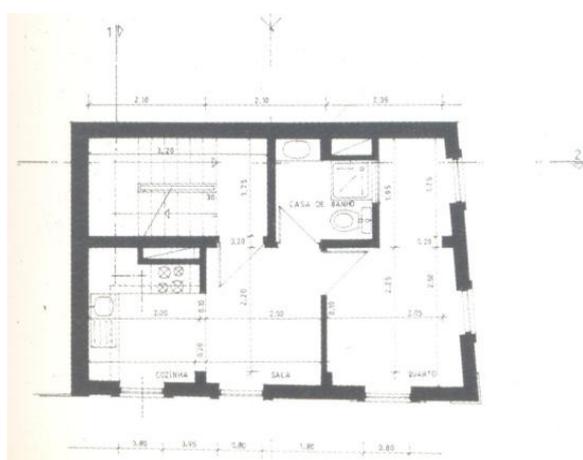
Planta do 2º ao 4º pavimento na travessa do Poço da Cidade nº 52-54. LISBOA, 1993, p.103.
